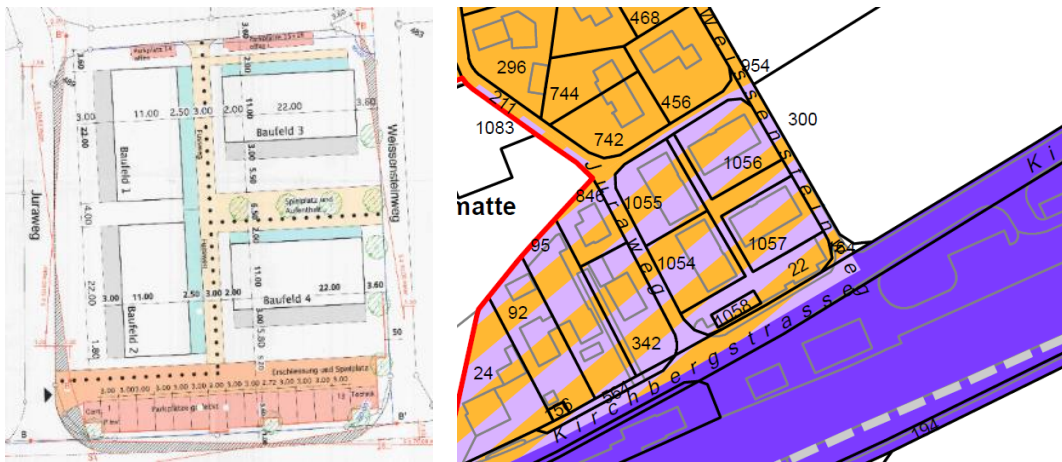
Auszug Überbauungsplan UeO Bahnhof und Ausschnitt neuer Zonenplan
